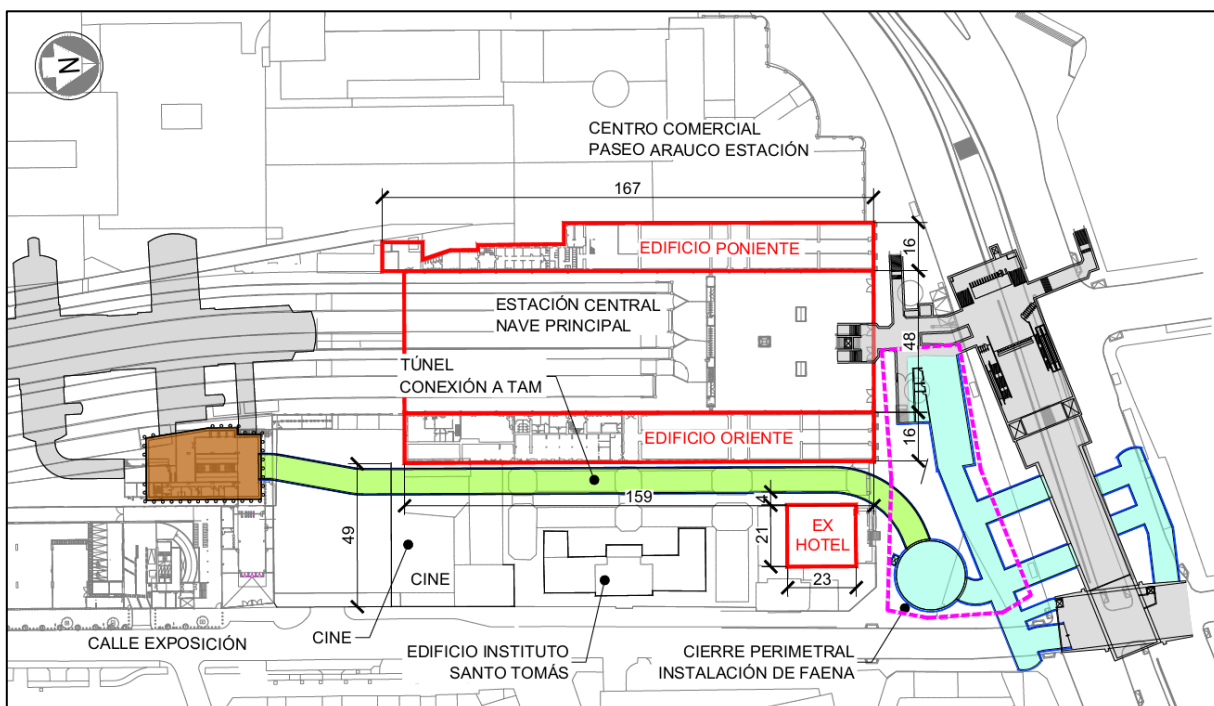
Planta con indicación en rojo de edificios parte del M.H. y en celeste las obras subterráneas del proyecto de ampliación.
